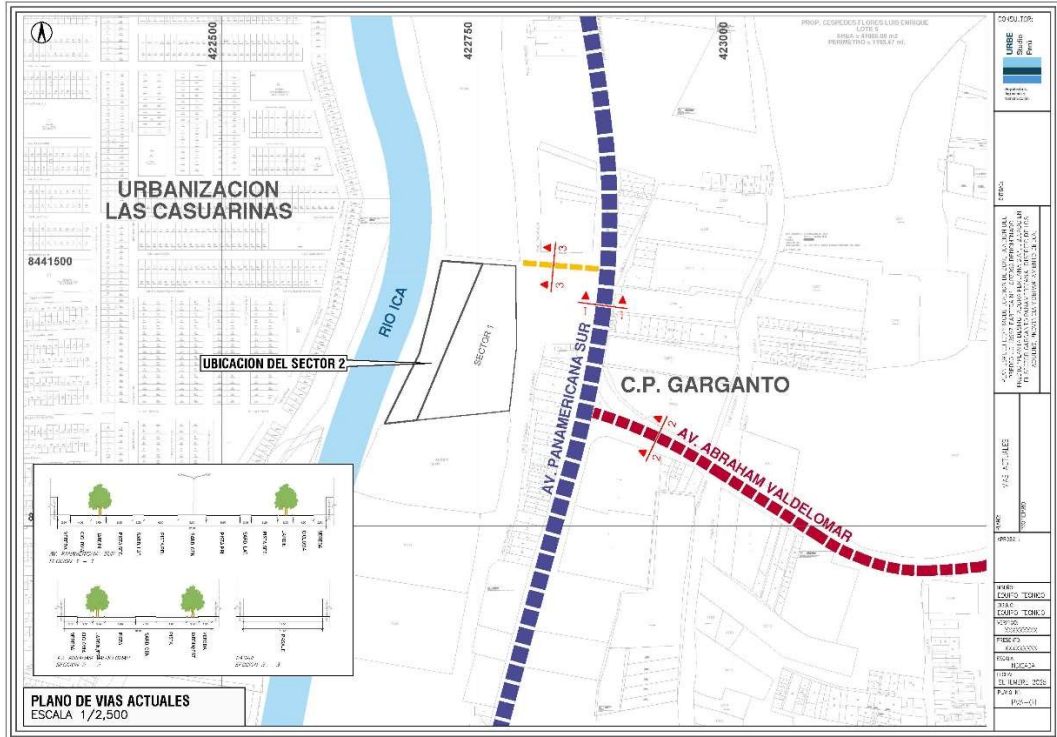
PLANO DE VIAS -SECTOR 2
